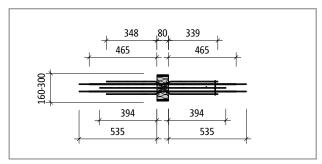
Schöck Isokorb® T type W-M1: Product layout
